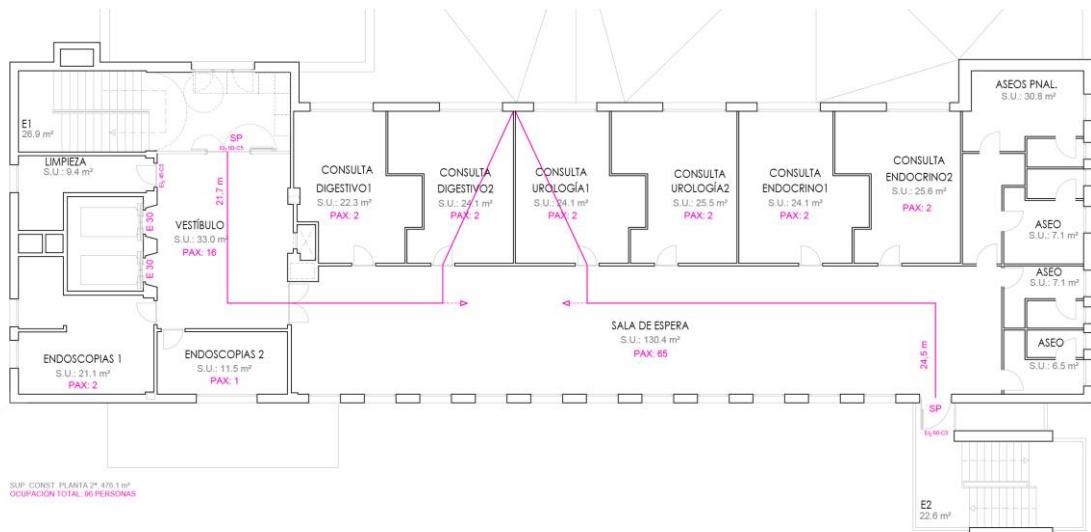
Planta de sectorización de la planta segunda. (Planta tipo)
